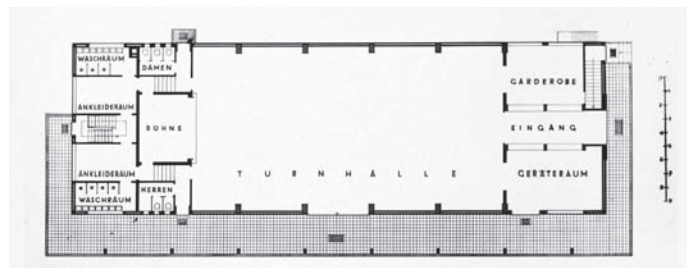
/7: Turnhalle Farmsen: Modellfoto und Grundriss EG o.M.
